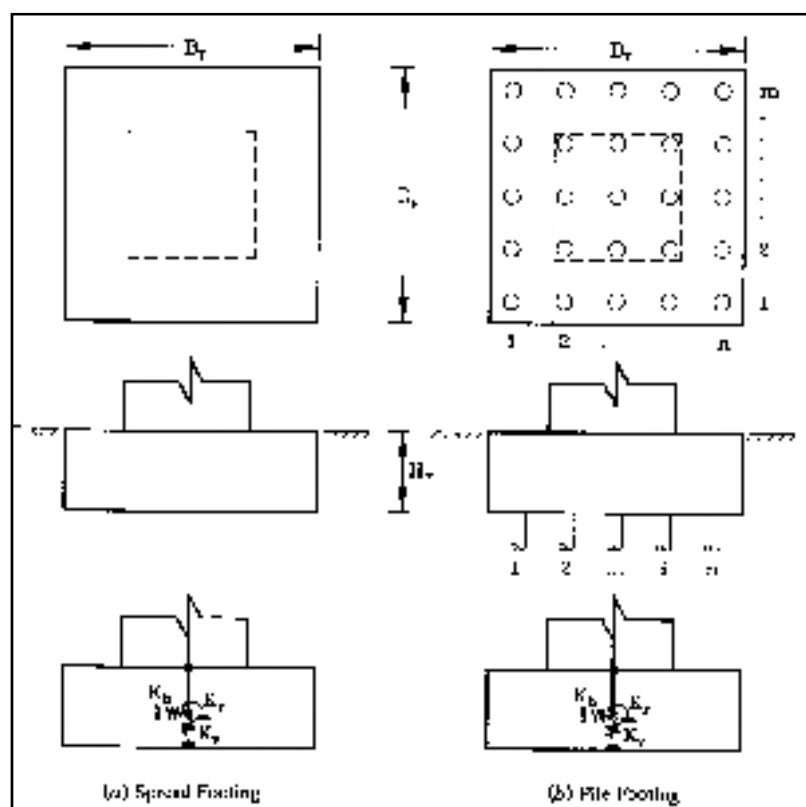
Fondations superficielles et fondations superficielles sur pieux.
